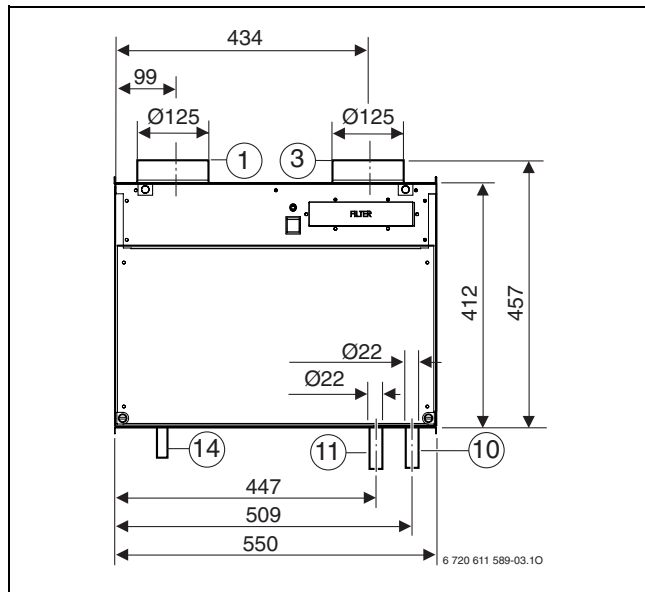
Bau- und Anschlussmaße (Maße in mm)
